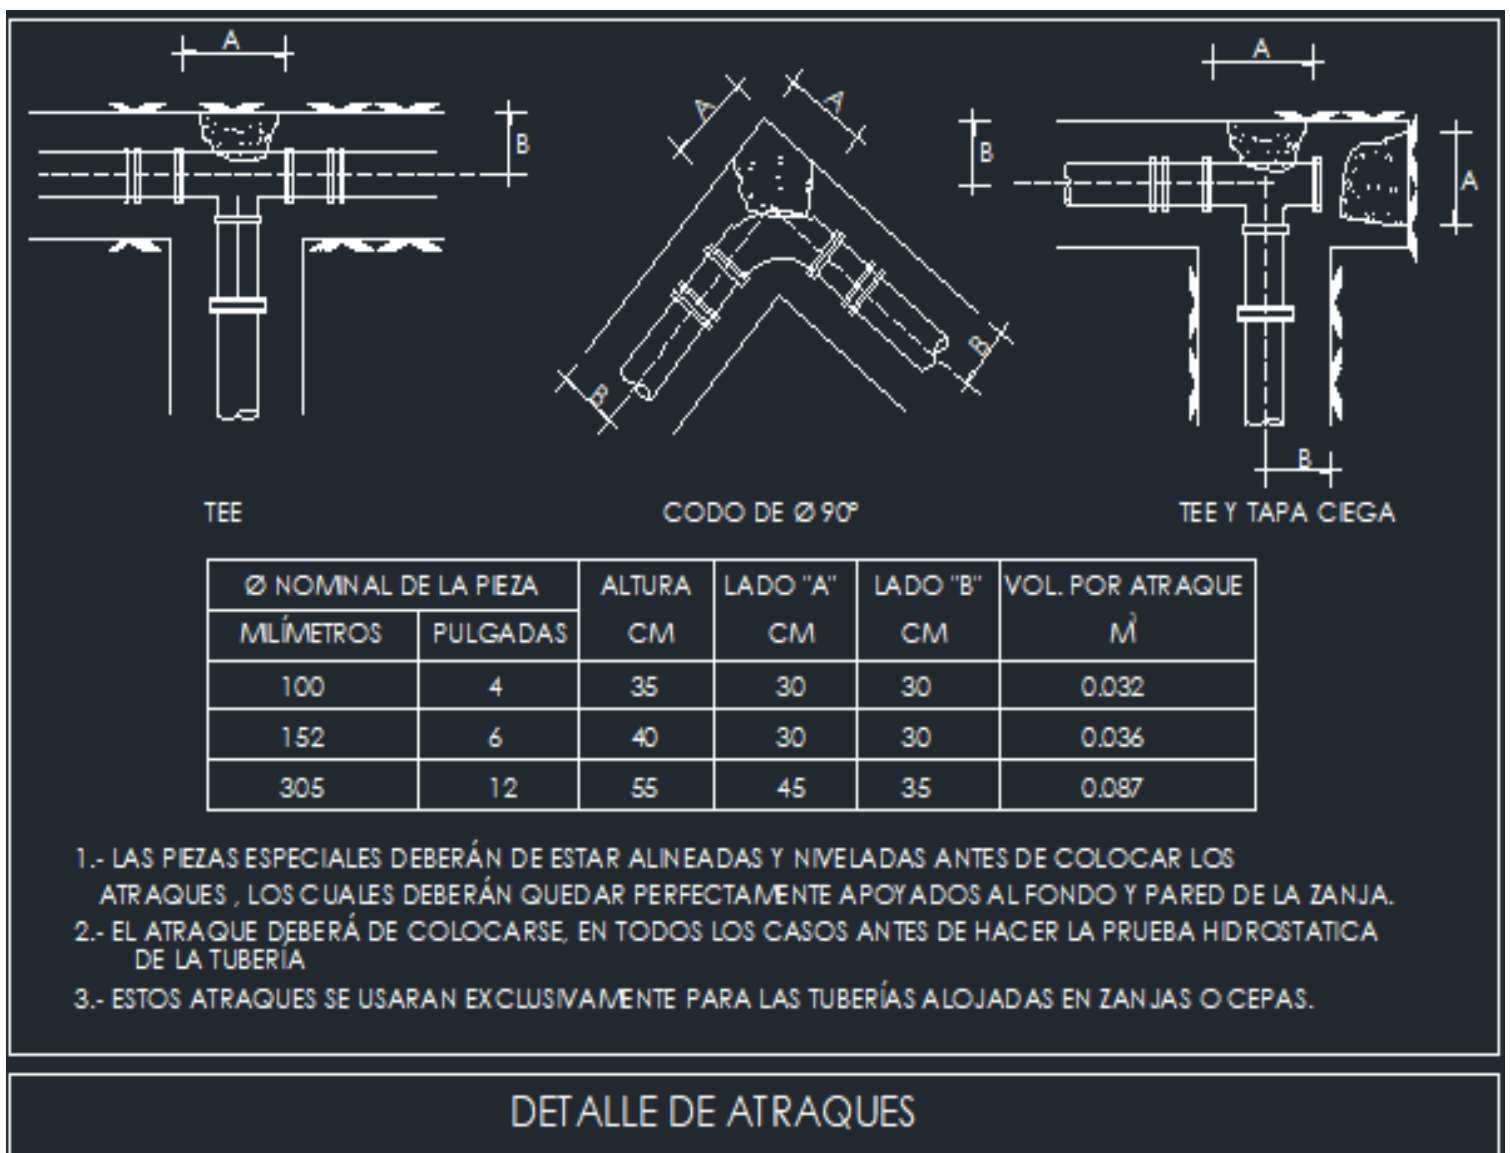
Detalle de elaboración de atraques de concreto. Fuente: elaboración propia
